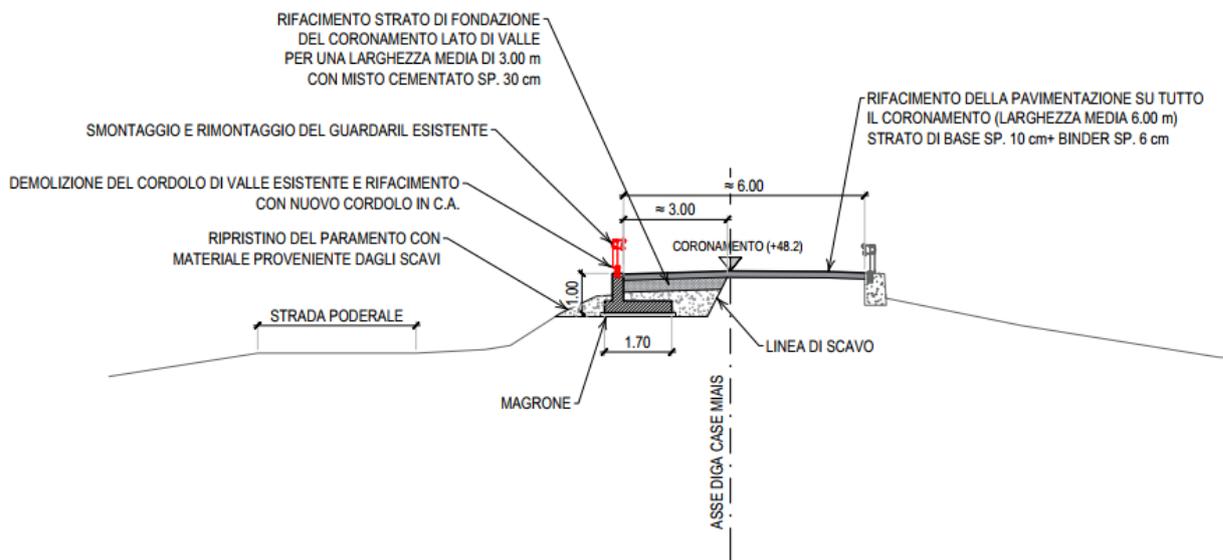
Sezione di intervento tipo 1, Case Miais
